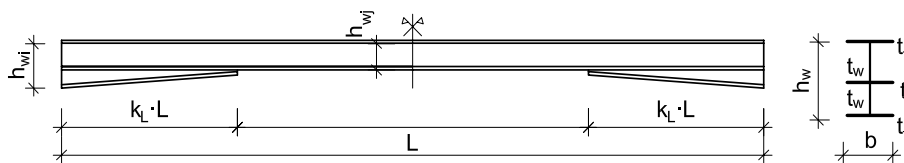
Walzprofil mit Voute – Bauteil mit beidseitigen Vouten
